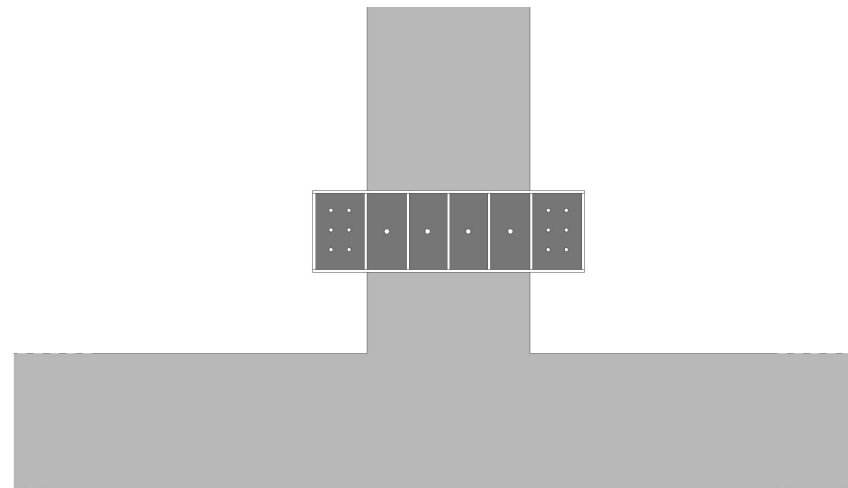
Carotaggio del pilastro sul lato lungo e posa dei secondi elementi di carpenteria
